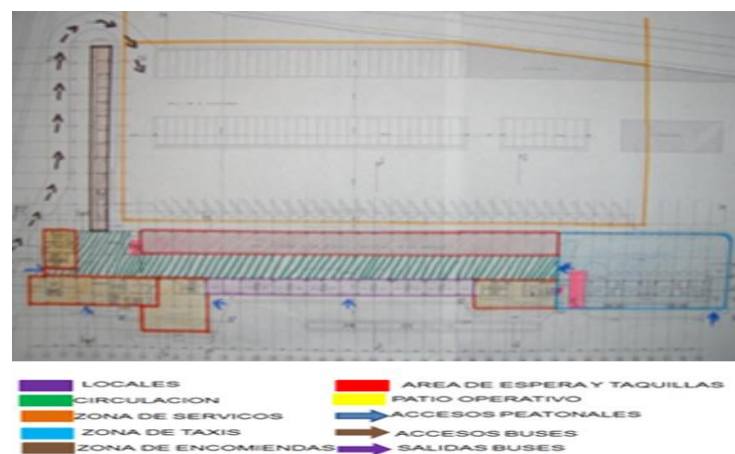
Distribución de zonas terminal de transporte Girardot. Adaptado de Plano publicado en la revista Escala 63.
